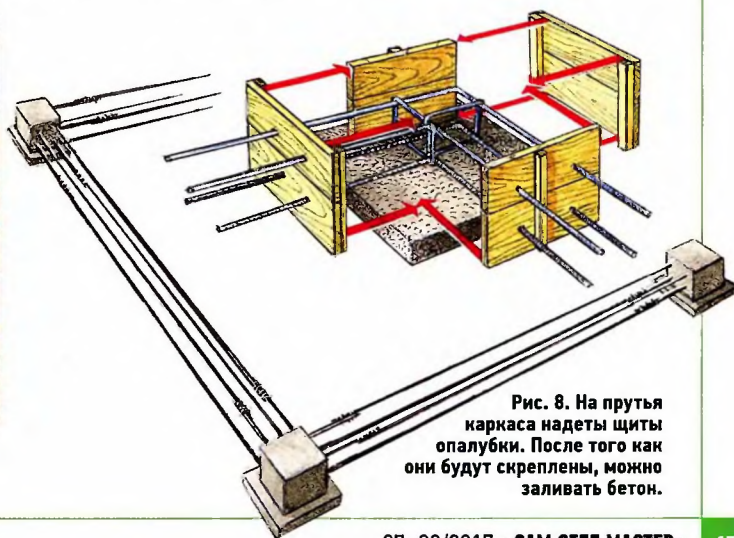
На прутья каркаса надеты щиты опалубки. После того как они будут скреплены, можно заливать бетон.
